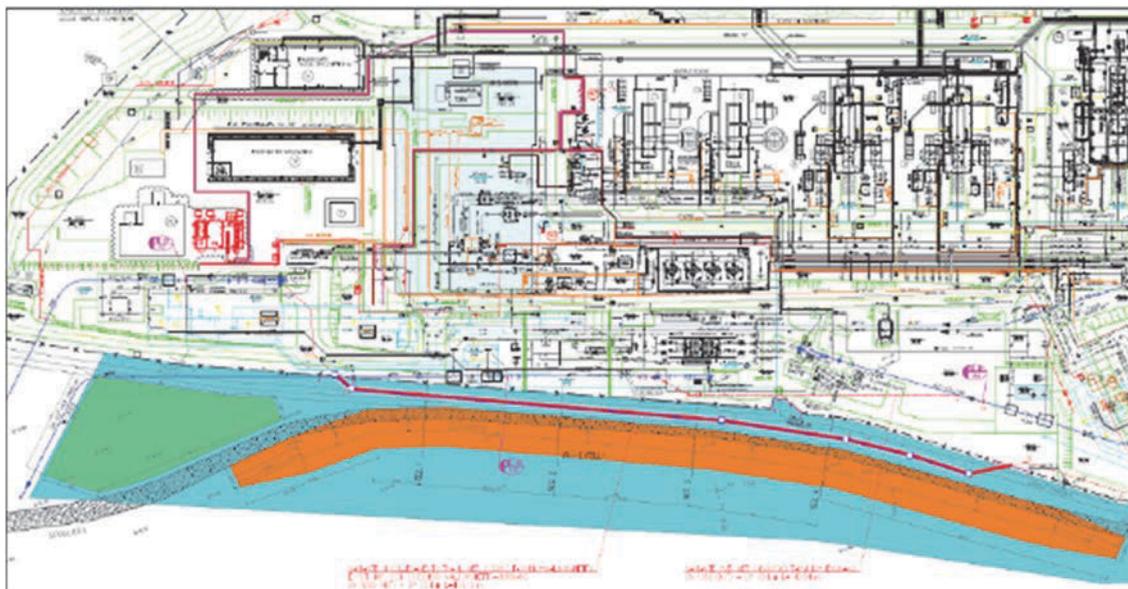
Stralcio della Planimetria di progetto con occupazione delle aree temporanee di lavoro (Rif. DIS. LB-3B-81000)
